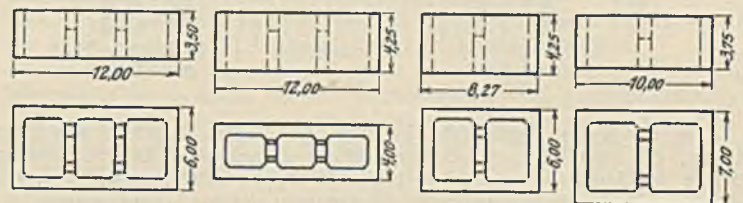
Aufrisse und Grundrisse verschiedener Hohlblöcke.
